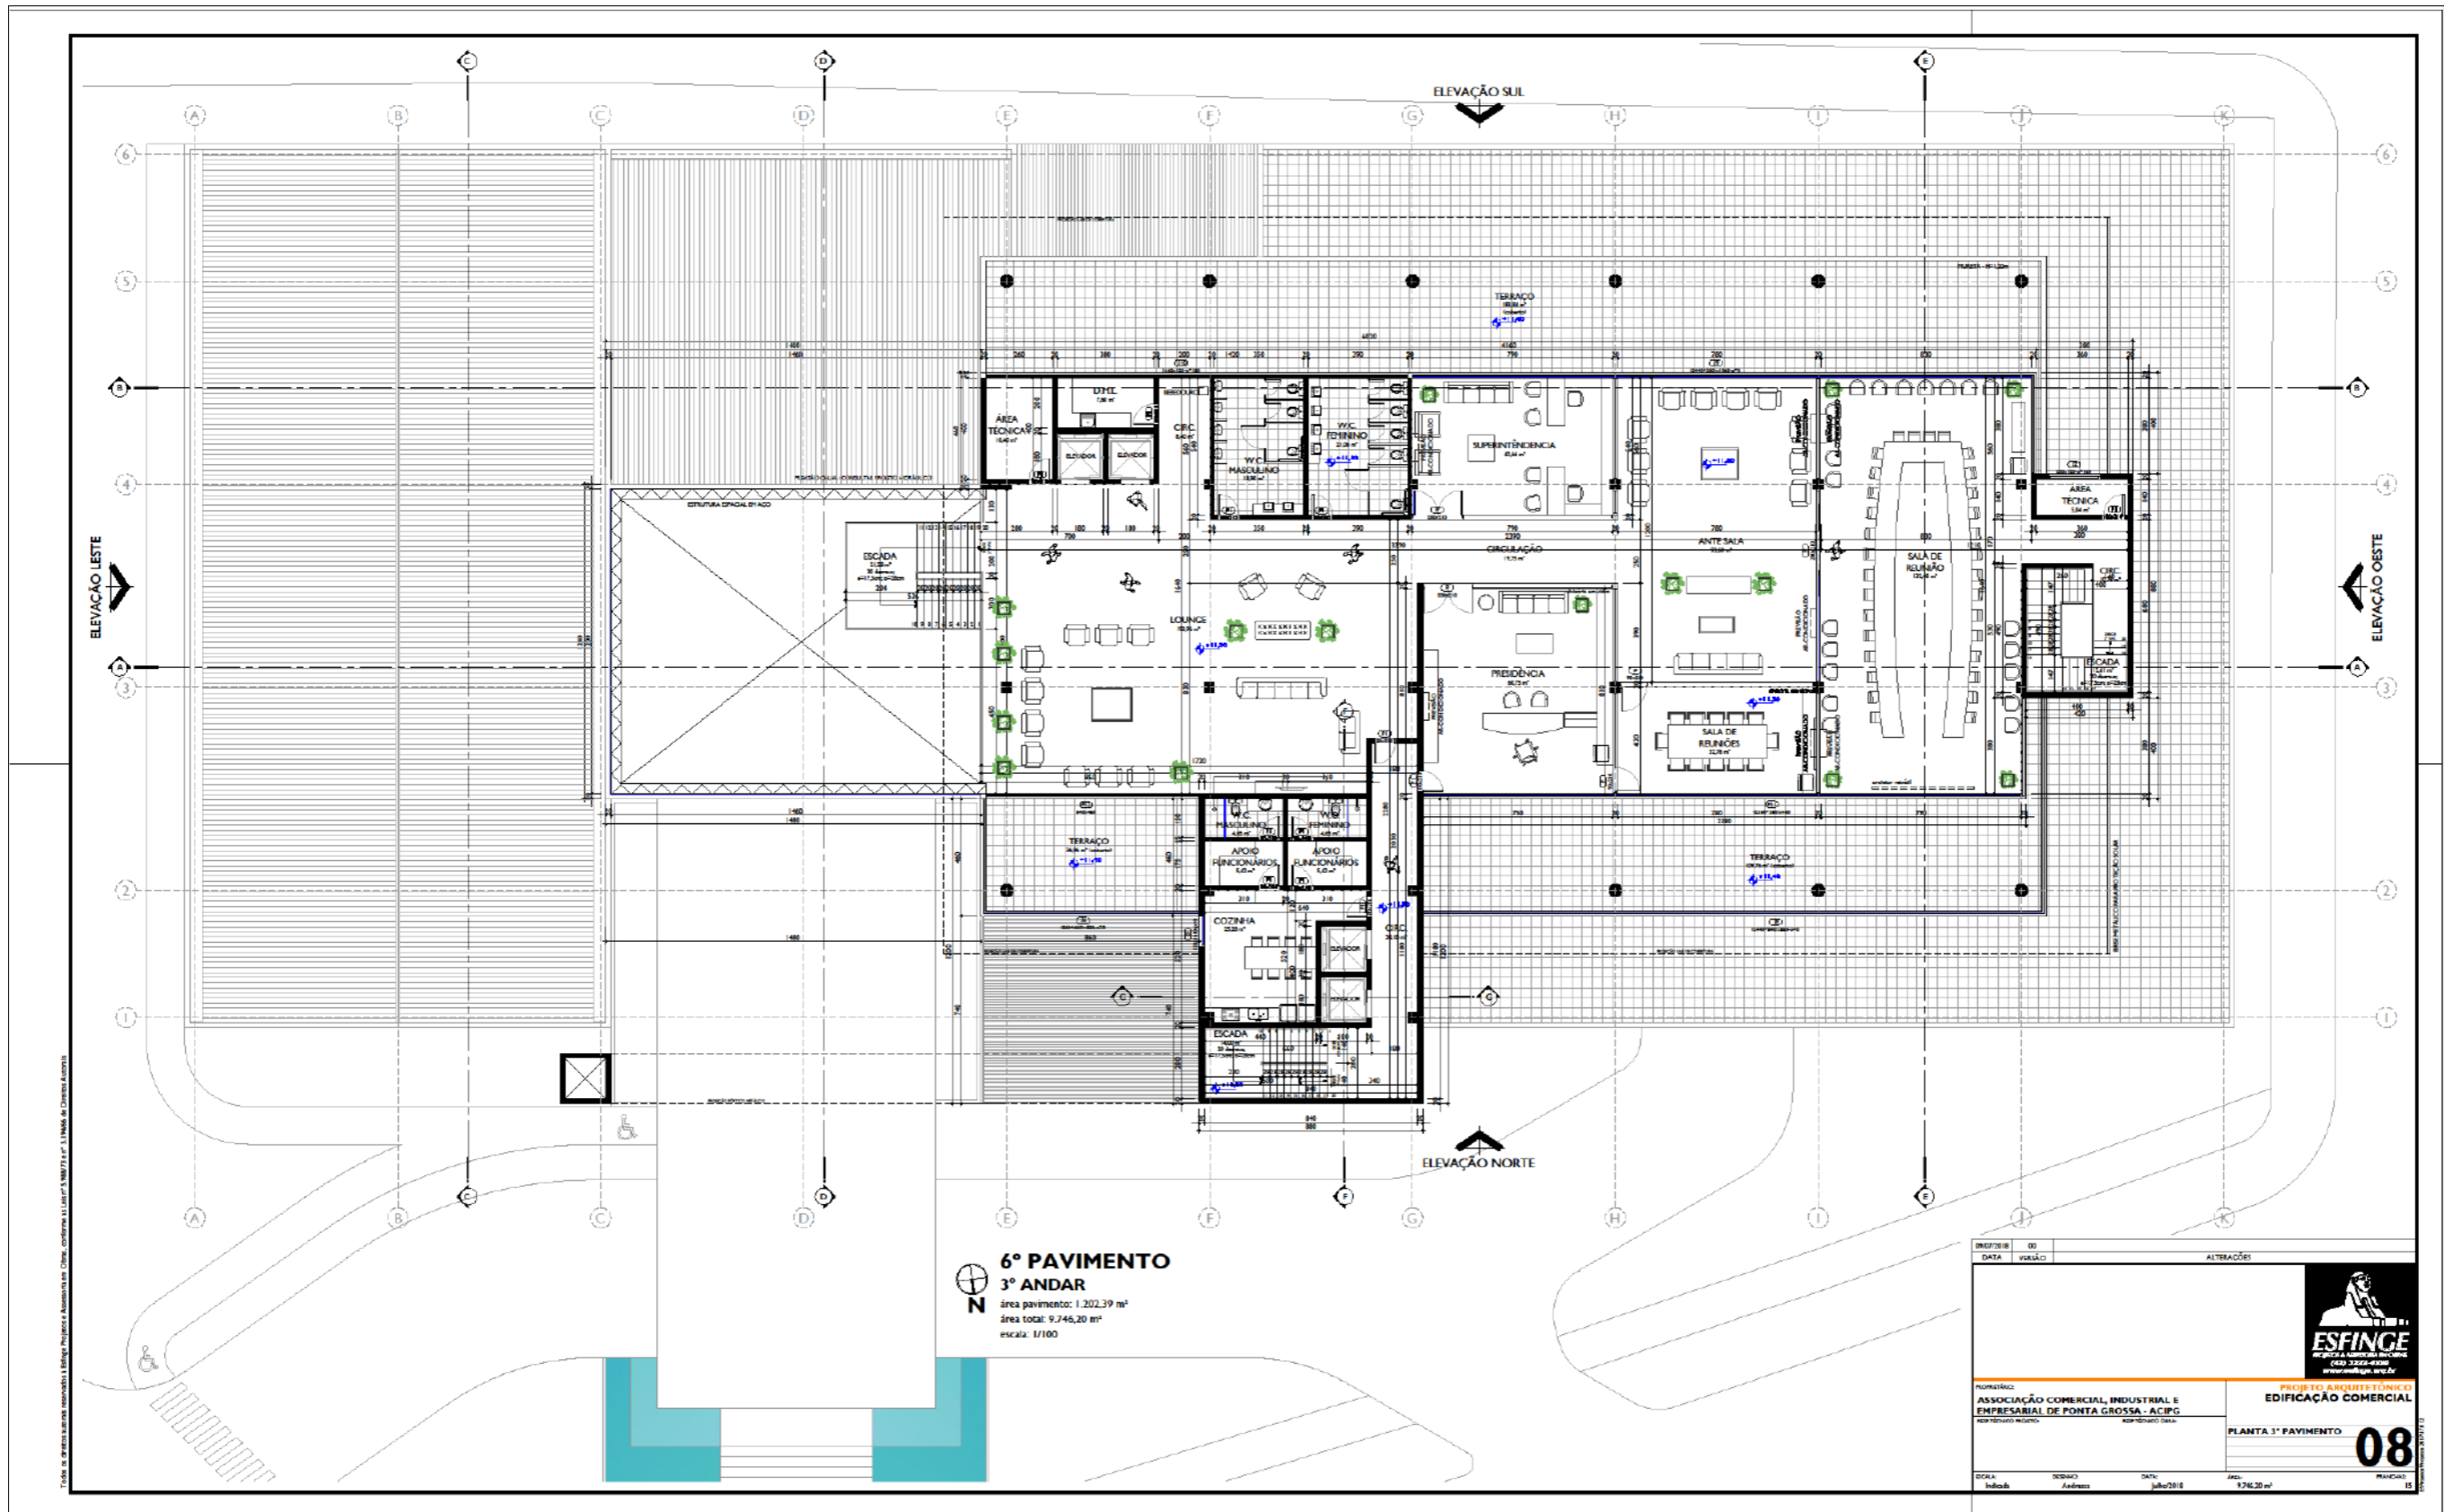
Planta 3º pavimento. Fonte: Esfinge Arquitetura e Engenharia (2018).
